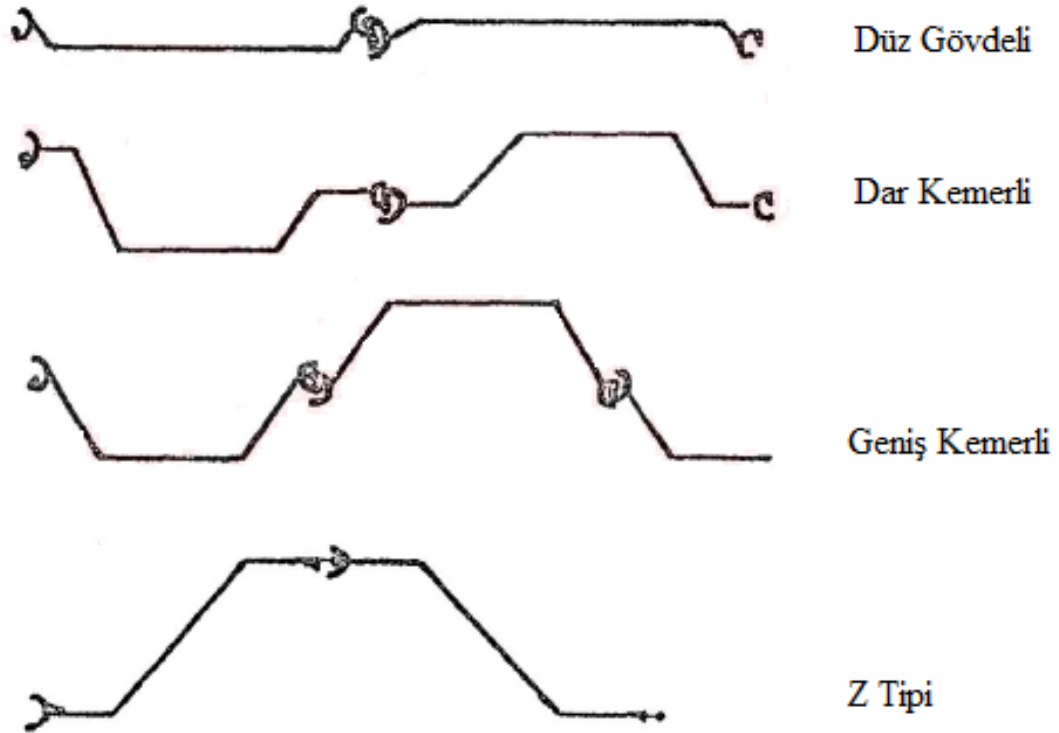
Prefabrik betonarme palplanş tipleri [16].
